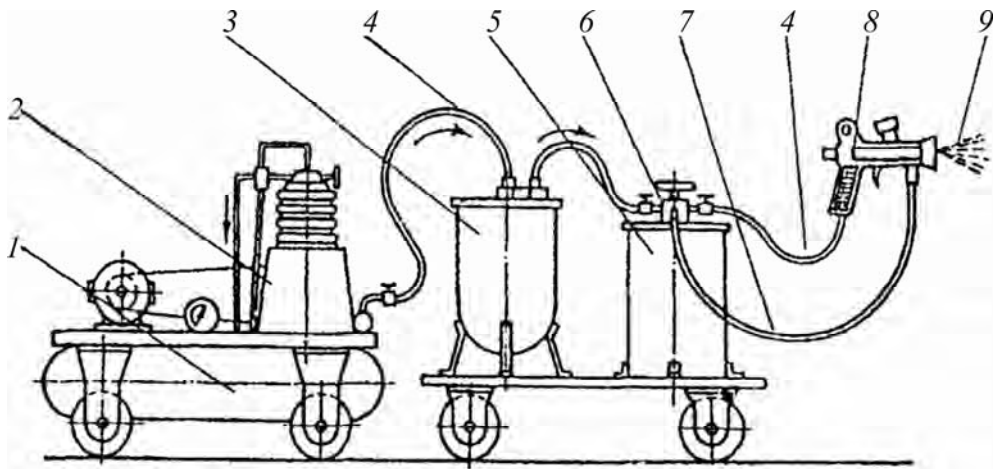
Схема компрессорного огрунтовочного агрегата, время высыхания грунтовок, нанесенных на свежеложенные стяжки — от 12 до 14 ч: 1 — воздухосборник; 2 — компрессор; 3 — маслоотделитель; 4 — воздушный шланг; 5 — красконагнетательный бак; 6 — редукционный вентиль; 7 — огрунтовочный шланг; 8 — краскораспылитель; 9 — факел
